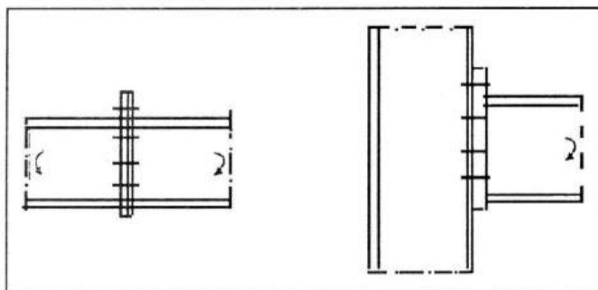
Assemblage poutre-poutre et poutre-poteau.
